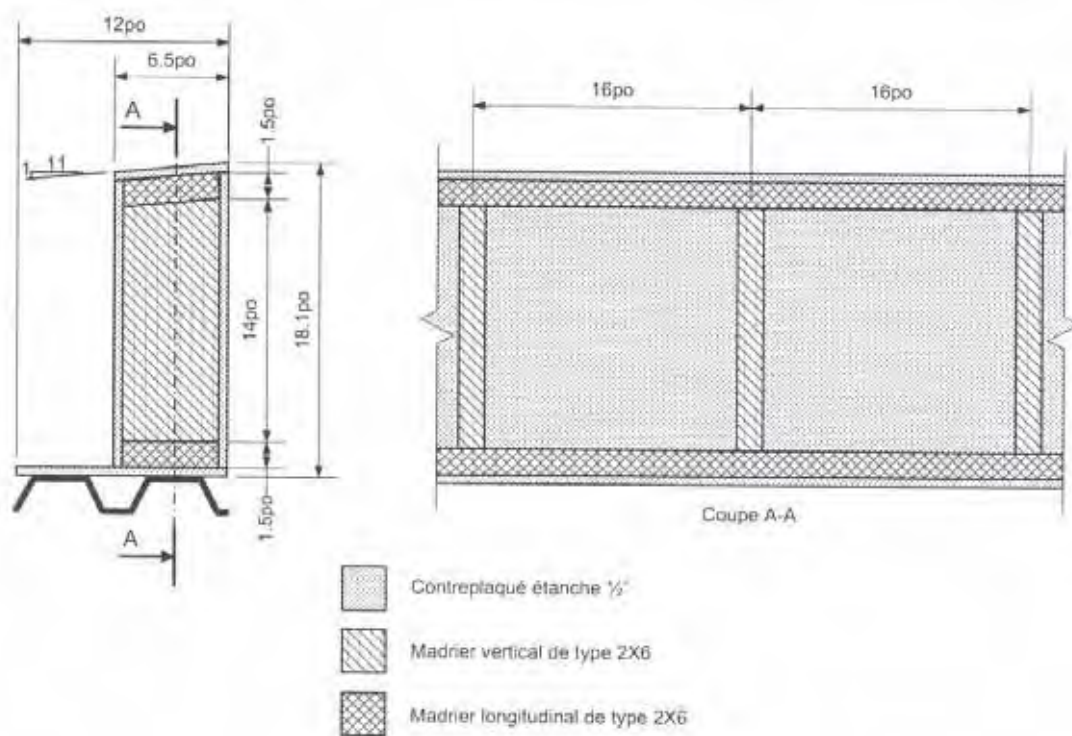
Parapet de type "sandwich" (disposition montrée pour essais INSR).
